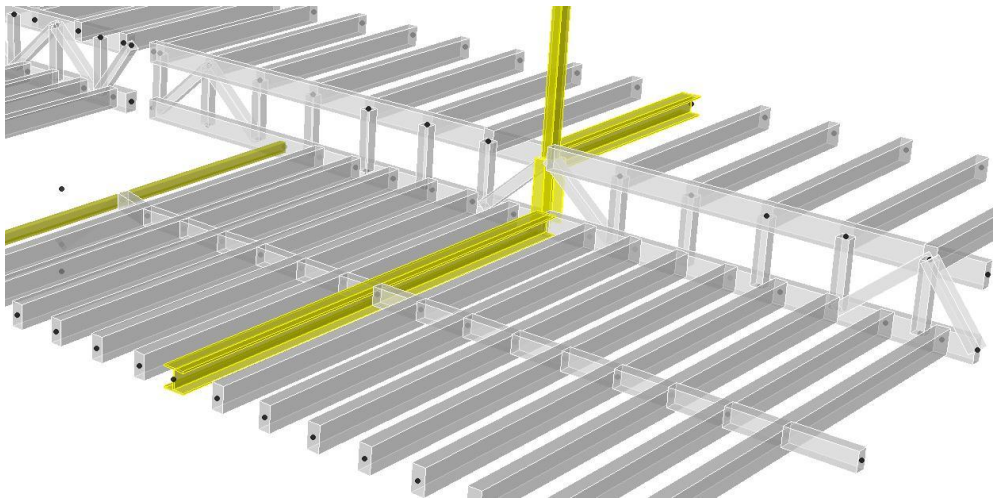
Pormenor da ligação do pilar à viga metálica da treliça
